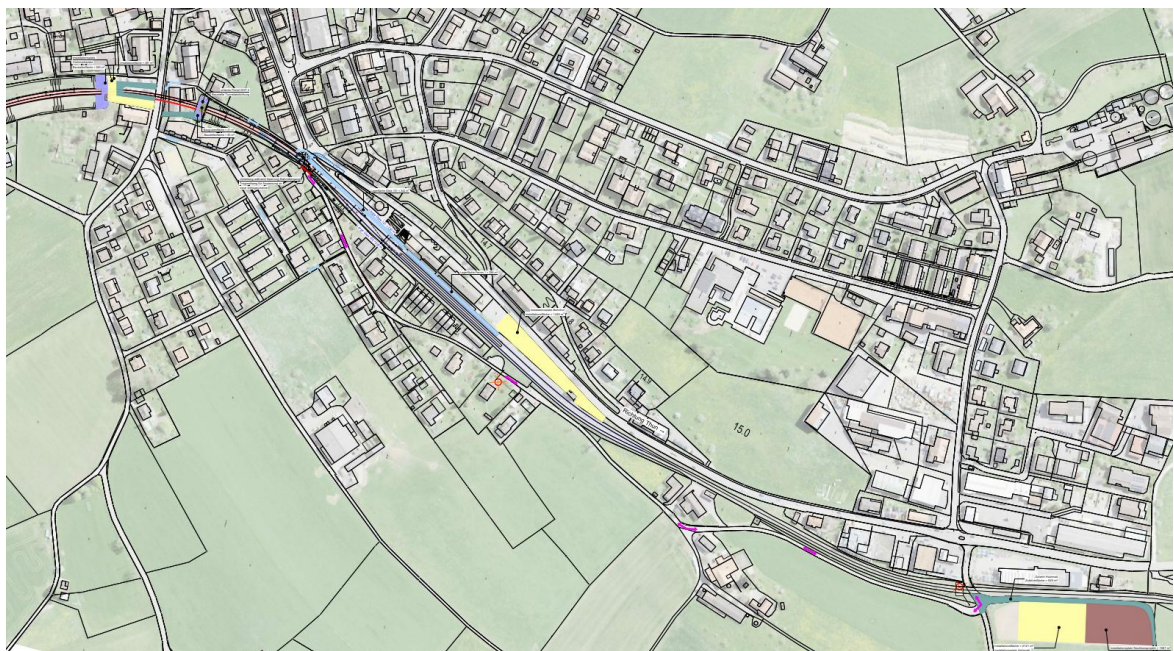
südliche Installationsfläche im Bereich GHT II, Bahnhof Grosshöchstetten und Holzmatt
